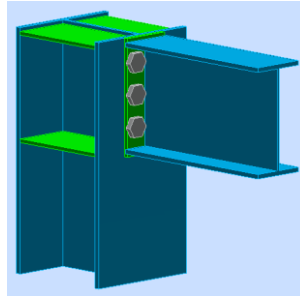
Pormenor da Ligação Coluna-Travessa (HEA 260 – IPE 240).
